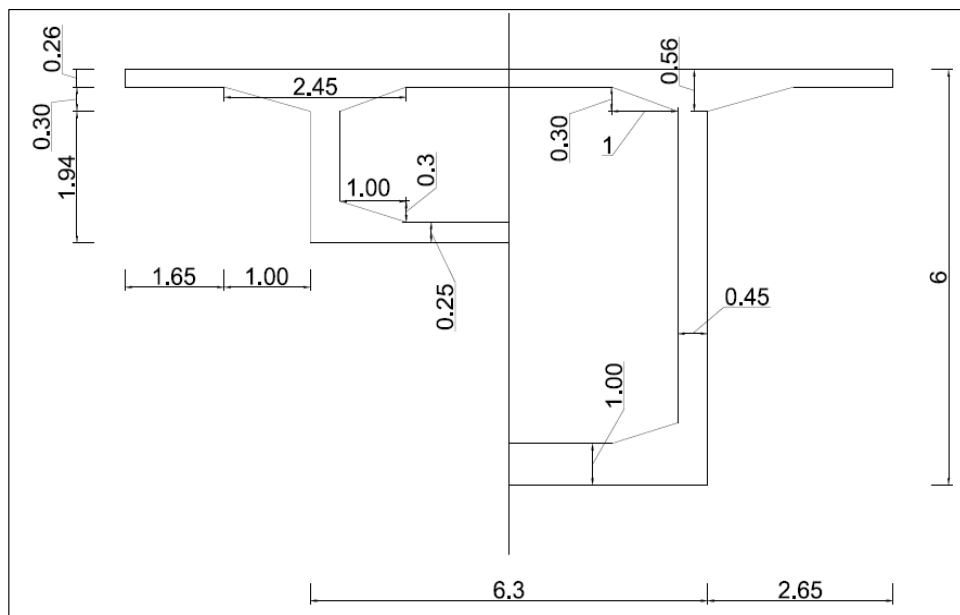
Sección transversal (izquierda: sección sobre estribos y centro de vano, derecha: sección sobre pila)
